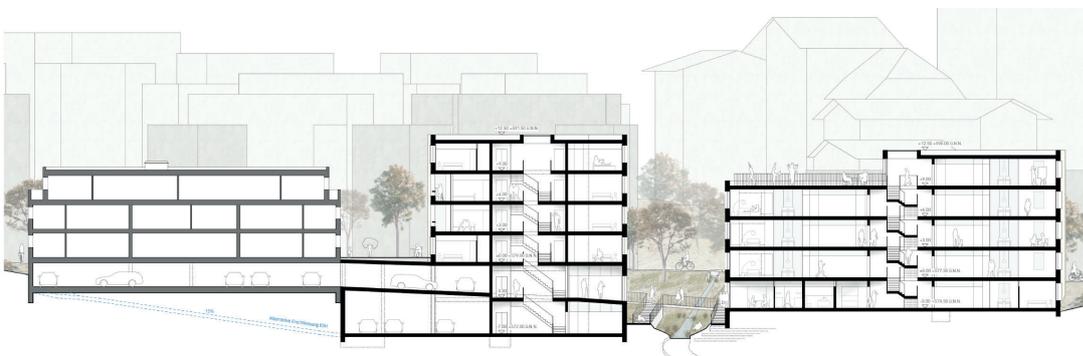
Längsschnitt durch den bestehenden und die beiden neuen Baukörper.
